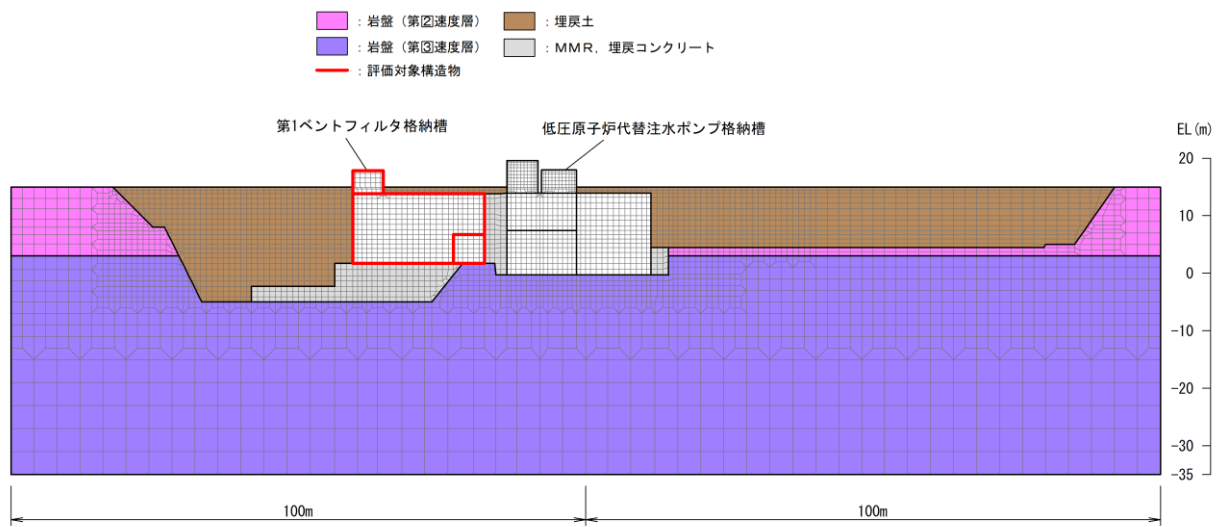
第 1 ベントフィルタ格納槽 地震応答解析モデル図 (C-C 断面)
